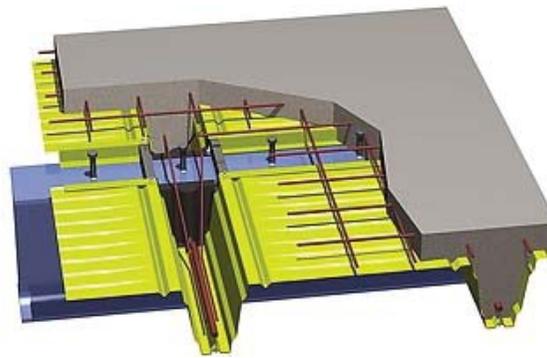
Stahstütze / Hoesch Additiv Decke
